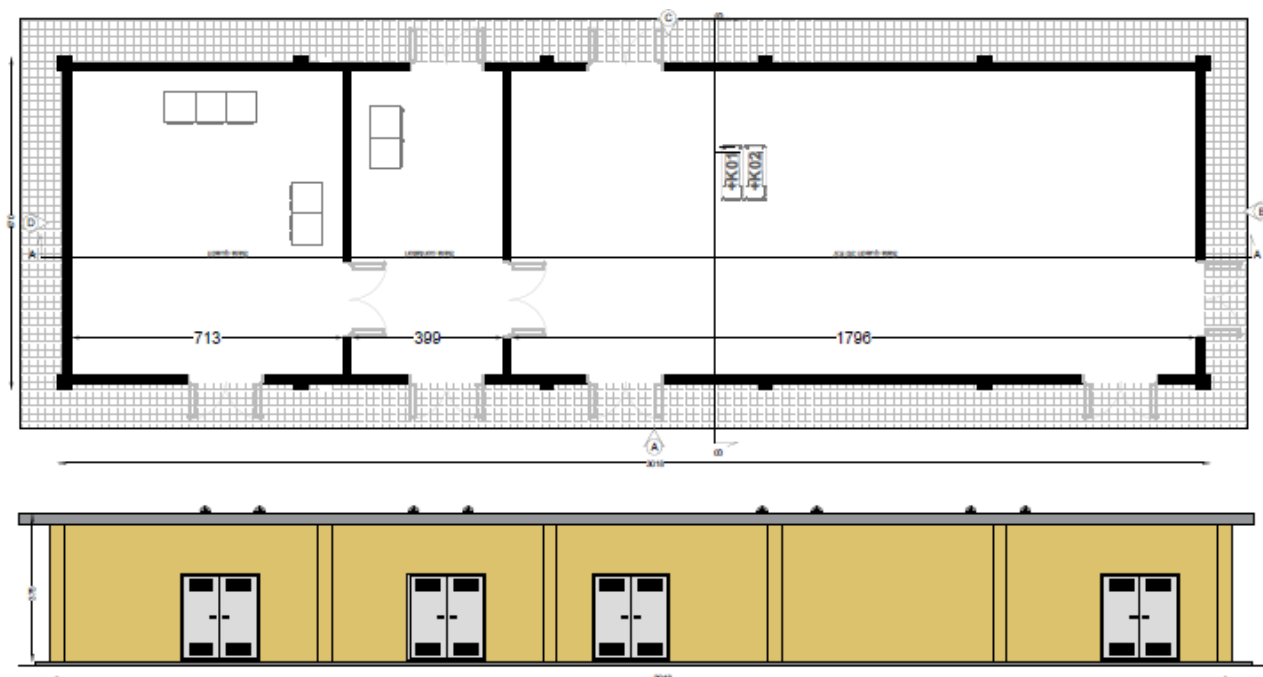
Pianta e prospetto tipo della cabina generale BESS
